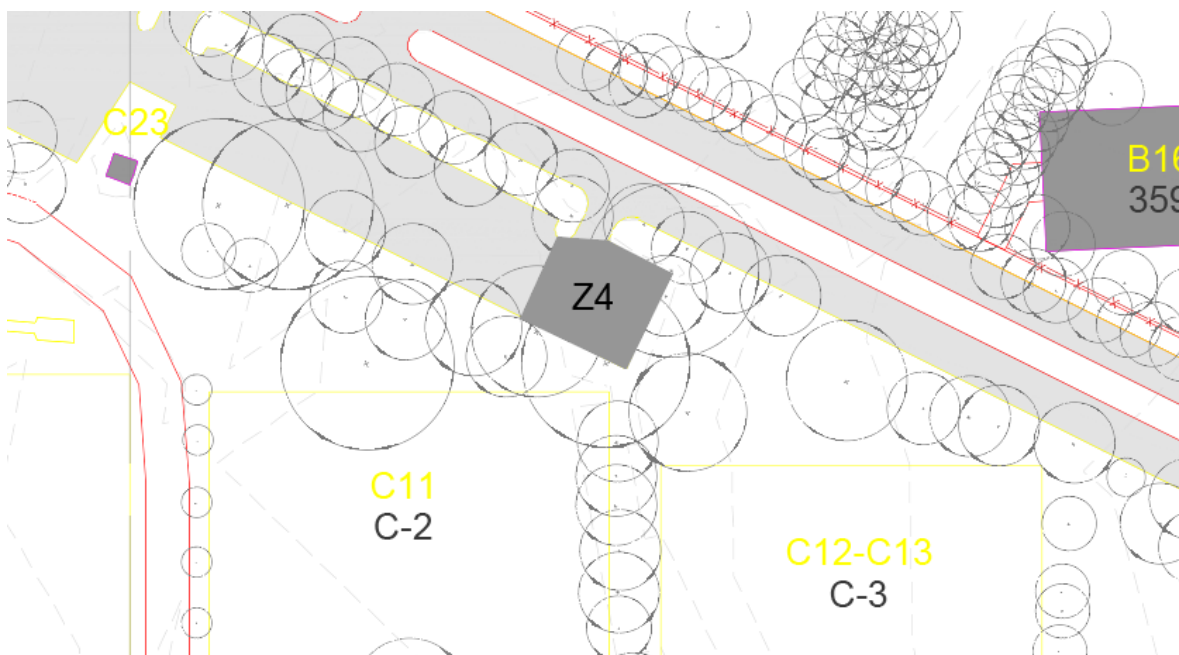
Construcción de la Zona 4 (Z4) parqueadero techado SP1.
